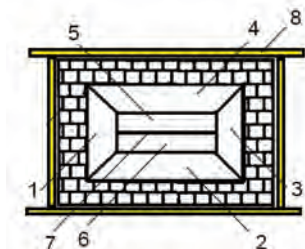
Схема предохранительной разрушающейся конструкции ограждения зданий.
